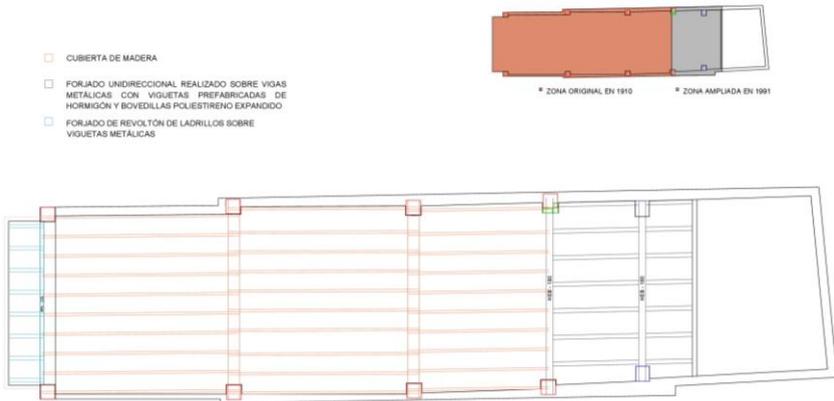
Plano de ampliación de forjado planta cubierta. 2018 Fuente: Propia
